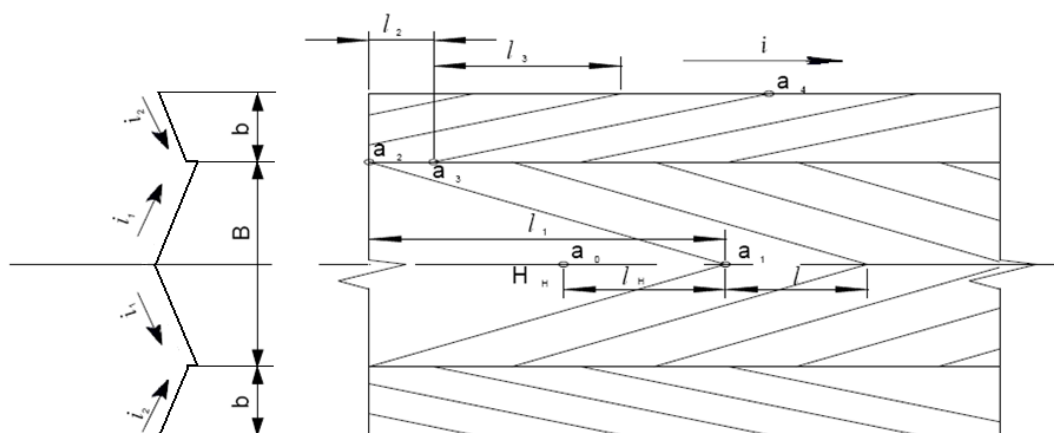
Схема к выполнению вертикальной планировки улицы
